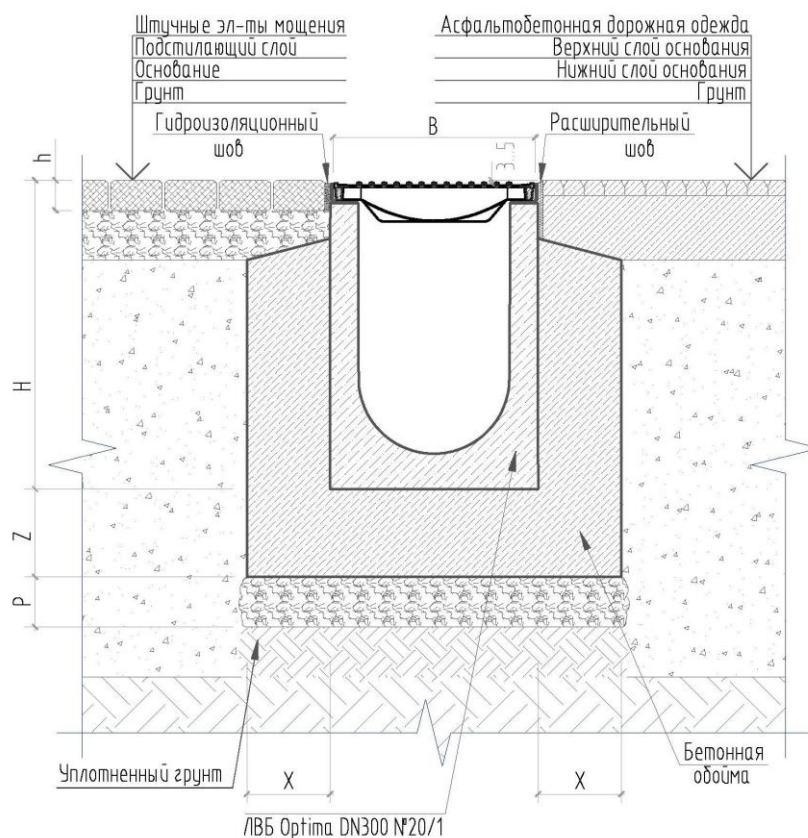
Монтаж бетонных лотков с асфальтобетонным покрытием и штучными элементами мощения.
